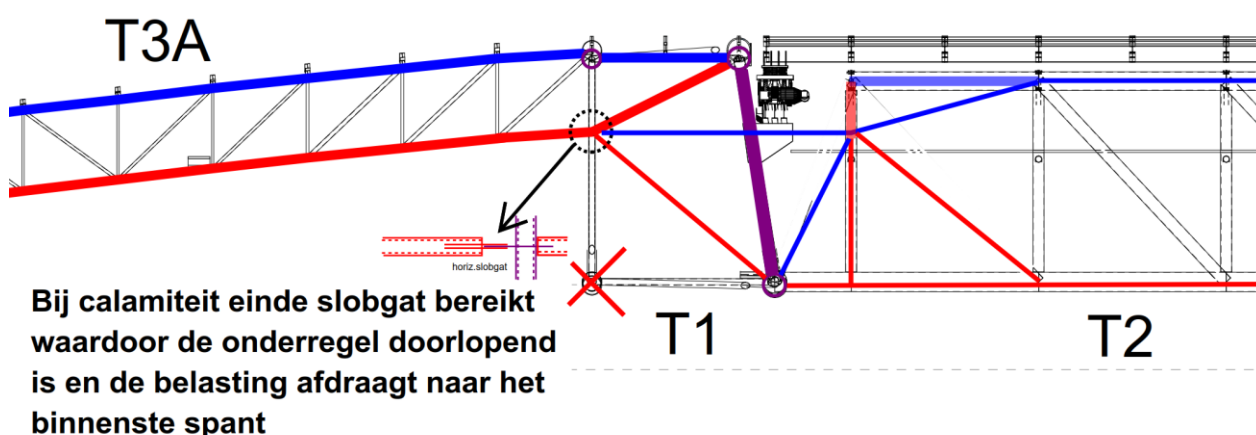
Detail aansluiting nul staven met horizontaal slobgat
